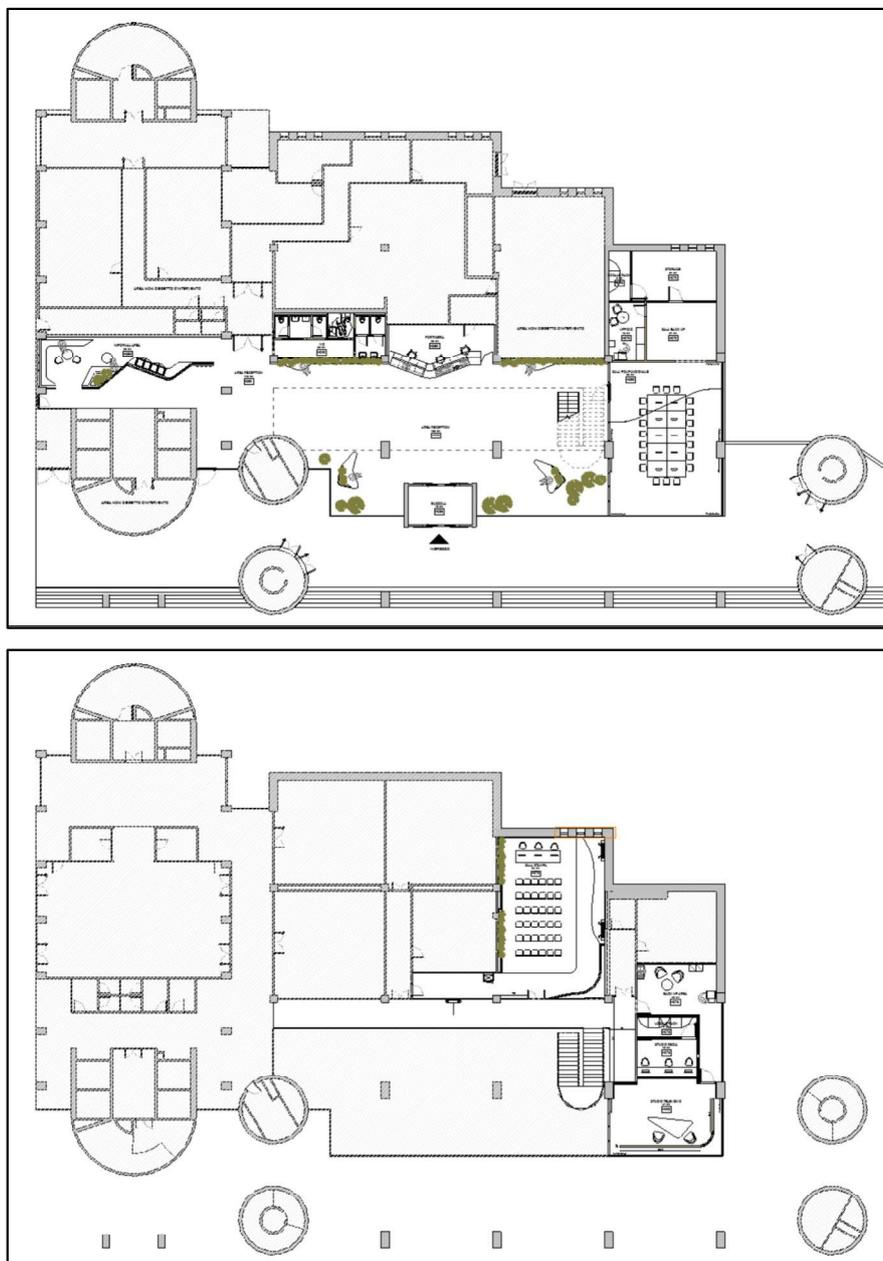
Delimitazione degli spazi oggetto di recente intervento di riqualificazione (in alto Piano Terra, in basso Piano ammezzato).
